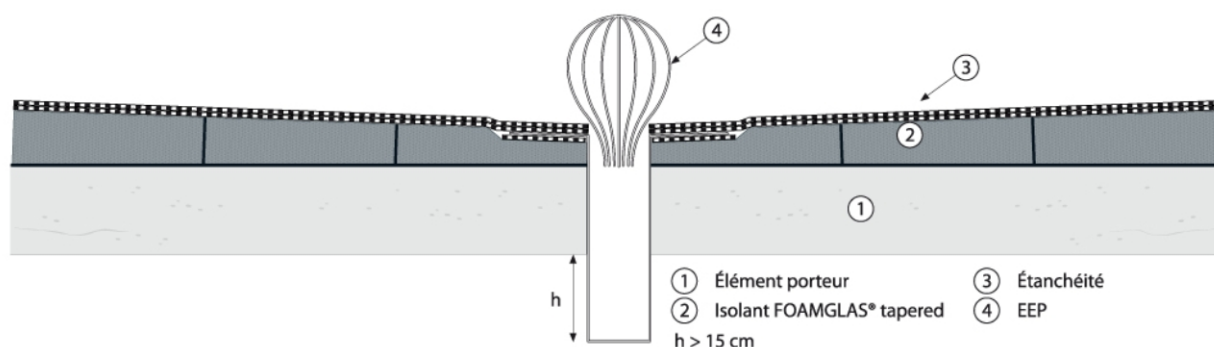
Coupe sur Entrée d'Eaux Pluviales (EEP) sur élément porteur béton
